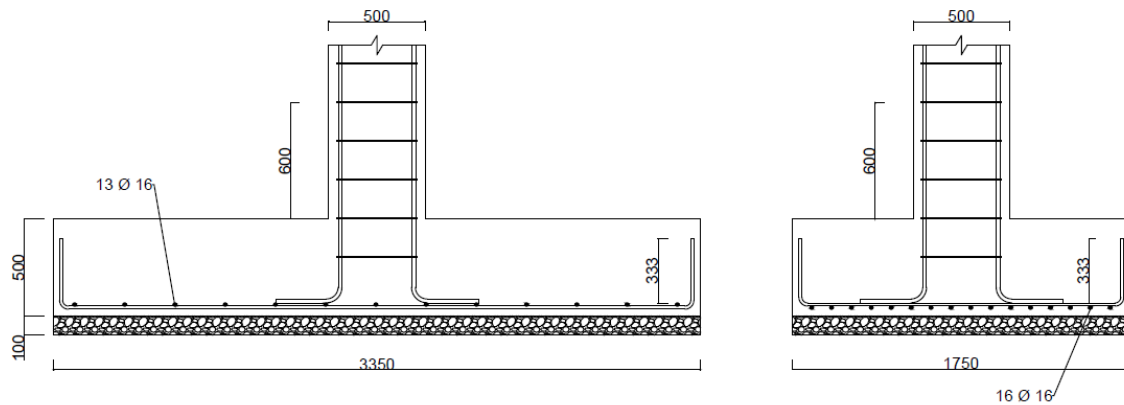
Dimensiones y armado de las zapatas intermedias (fuente: elaboración propia)
